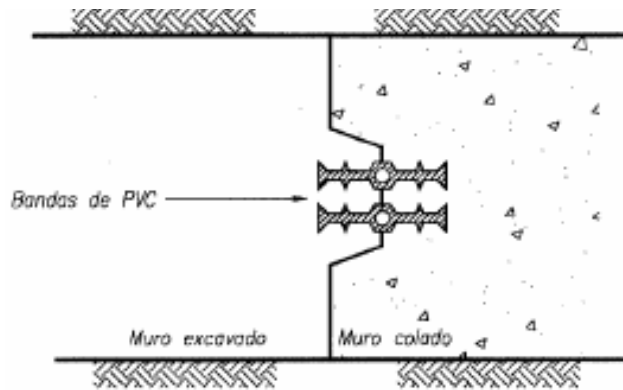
Vista en planta. Junta doble sello en pantallas (SMMS,2002)
